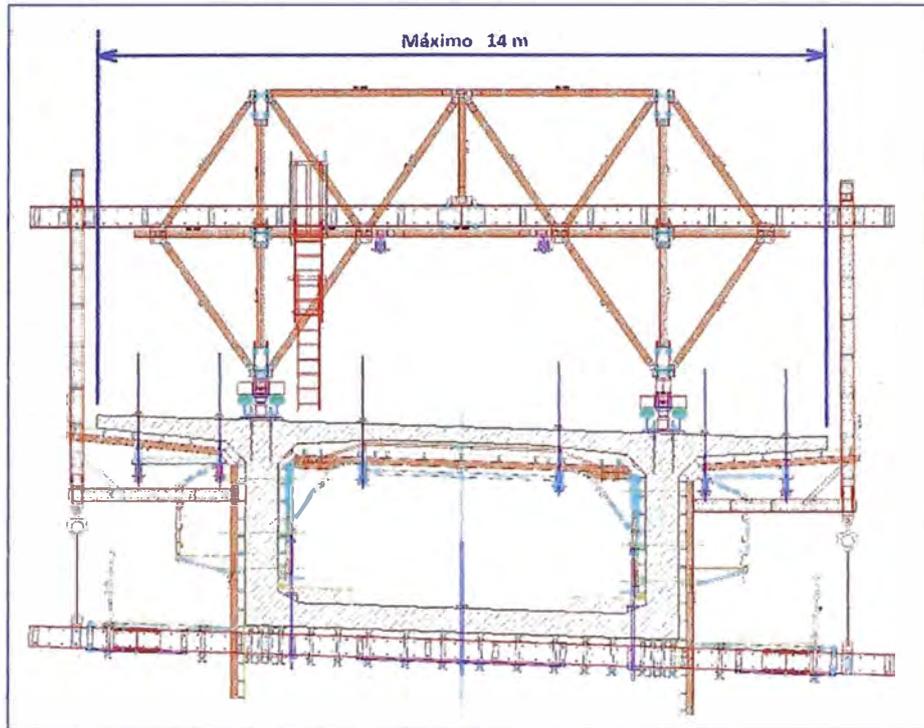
Ancho de viaducto máximo permitido - Fuente: Ulma C y E, S. Coop.
